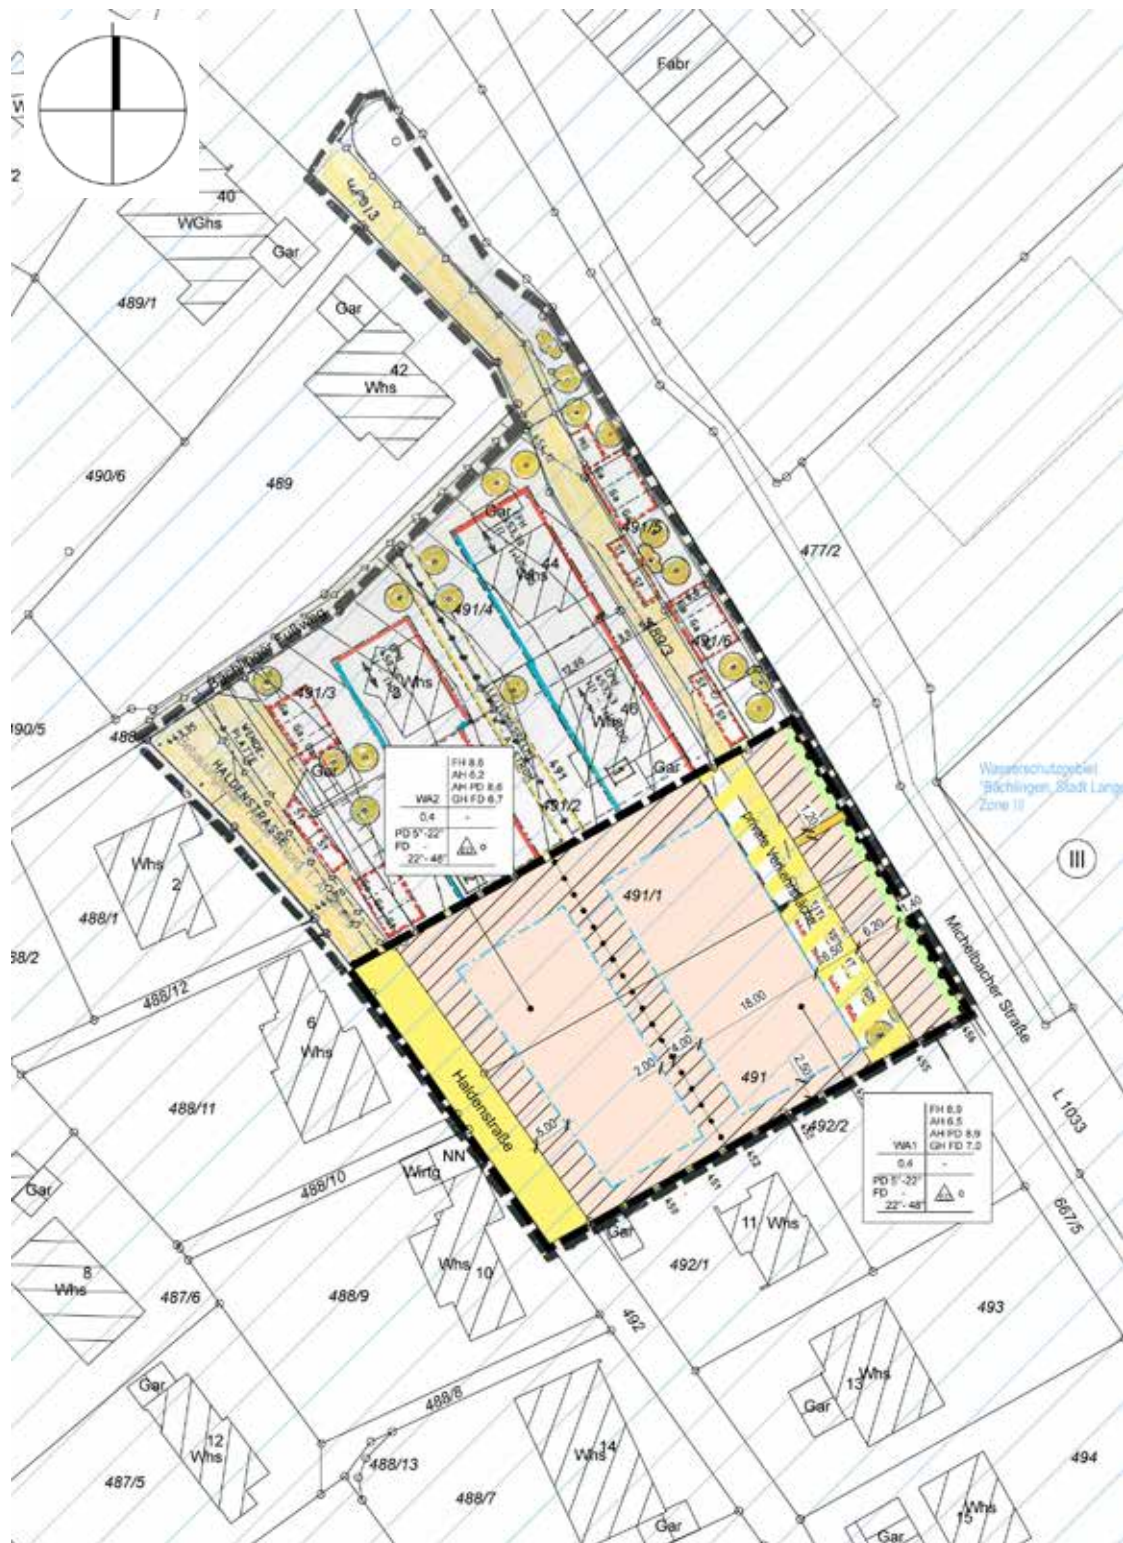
Ausschnitt alter Bebauungsplan und neuer Geltungsbereich, 1:1000
